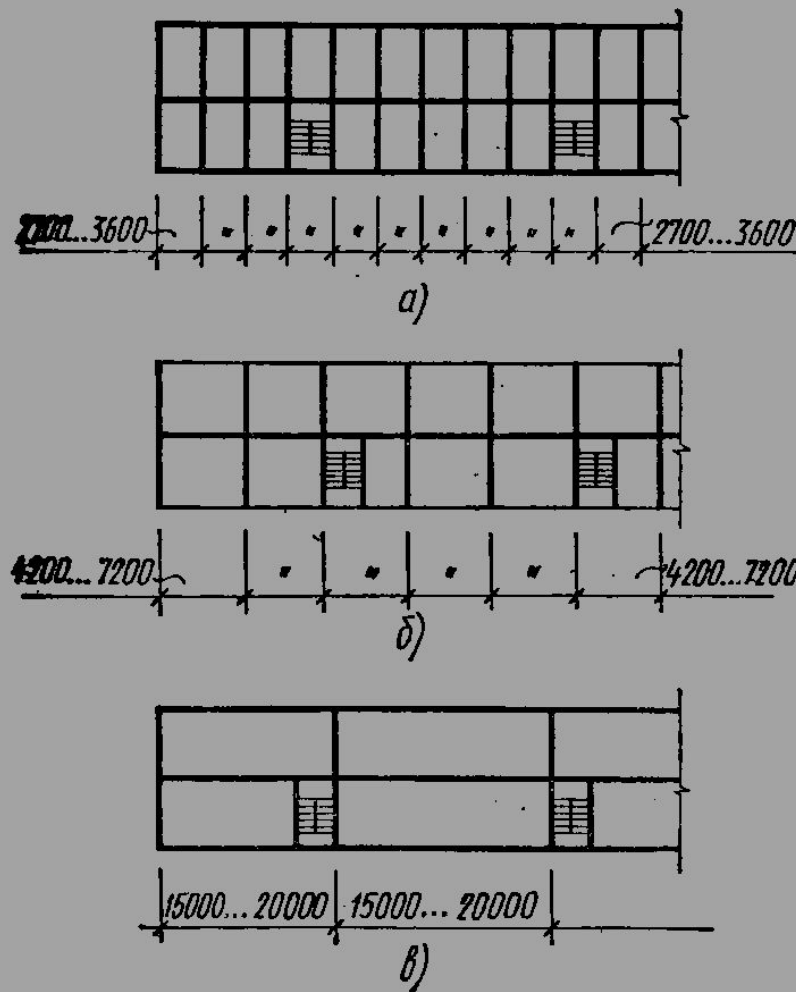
Конструктивные схемы бескаркасных крупнопанельных зданий:
